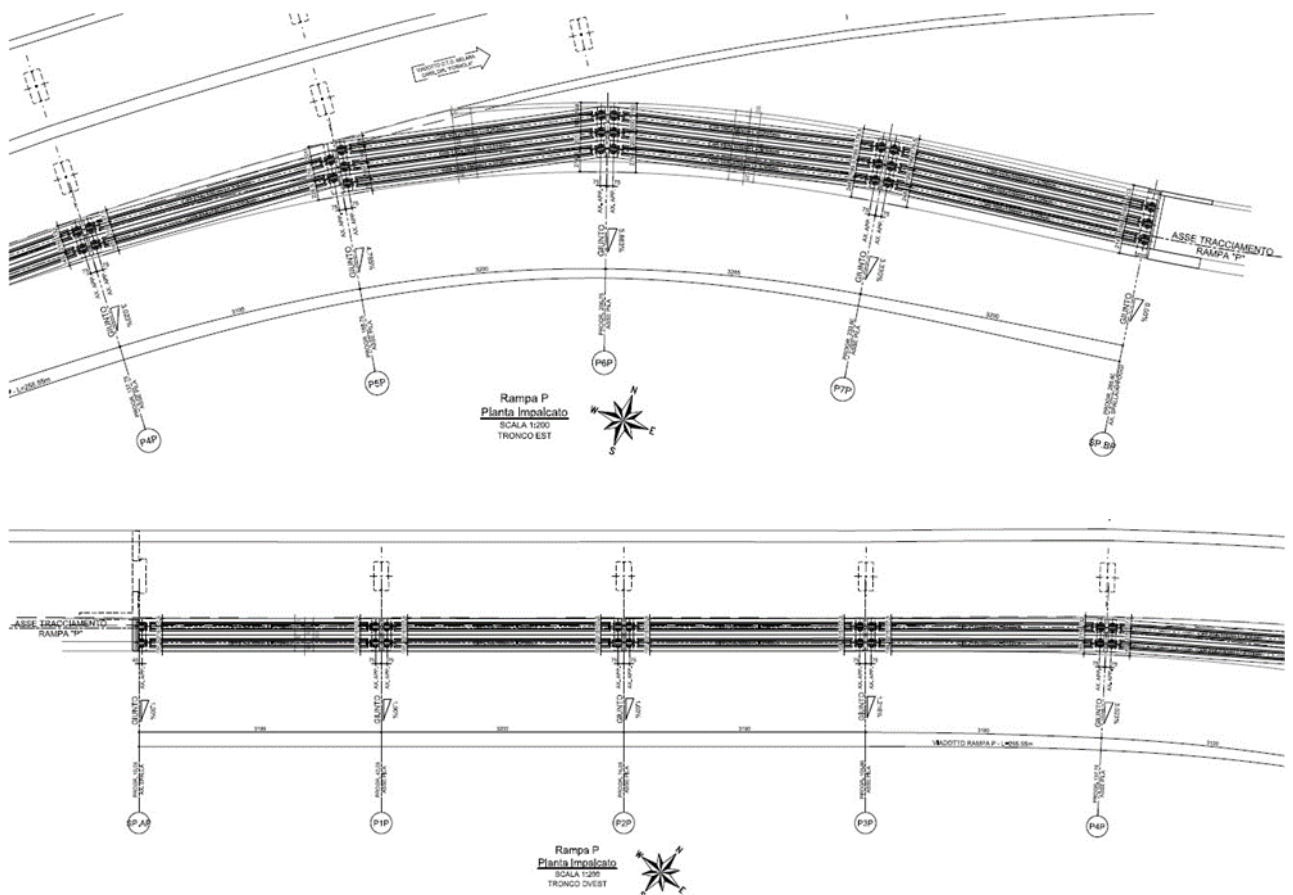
Planimetria Rampa P svincolo Melara
